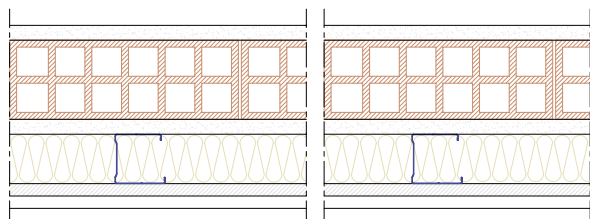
Esempio di sistema placcante a parete, controparete in lastre di gesso rivestito.
